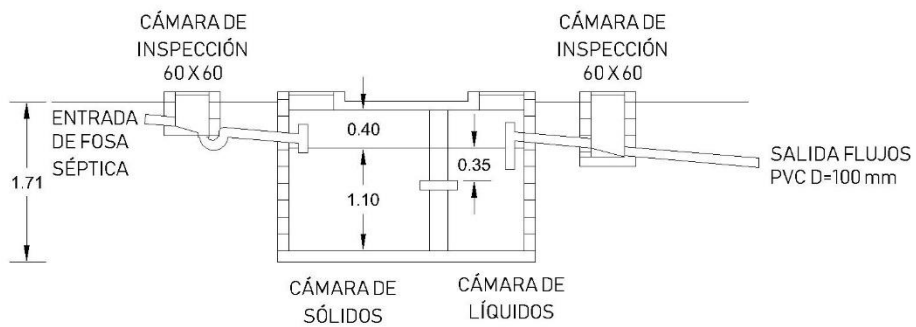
Detalles de fosa séptica en alzado.
